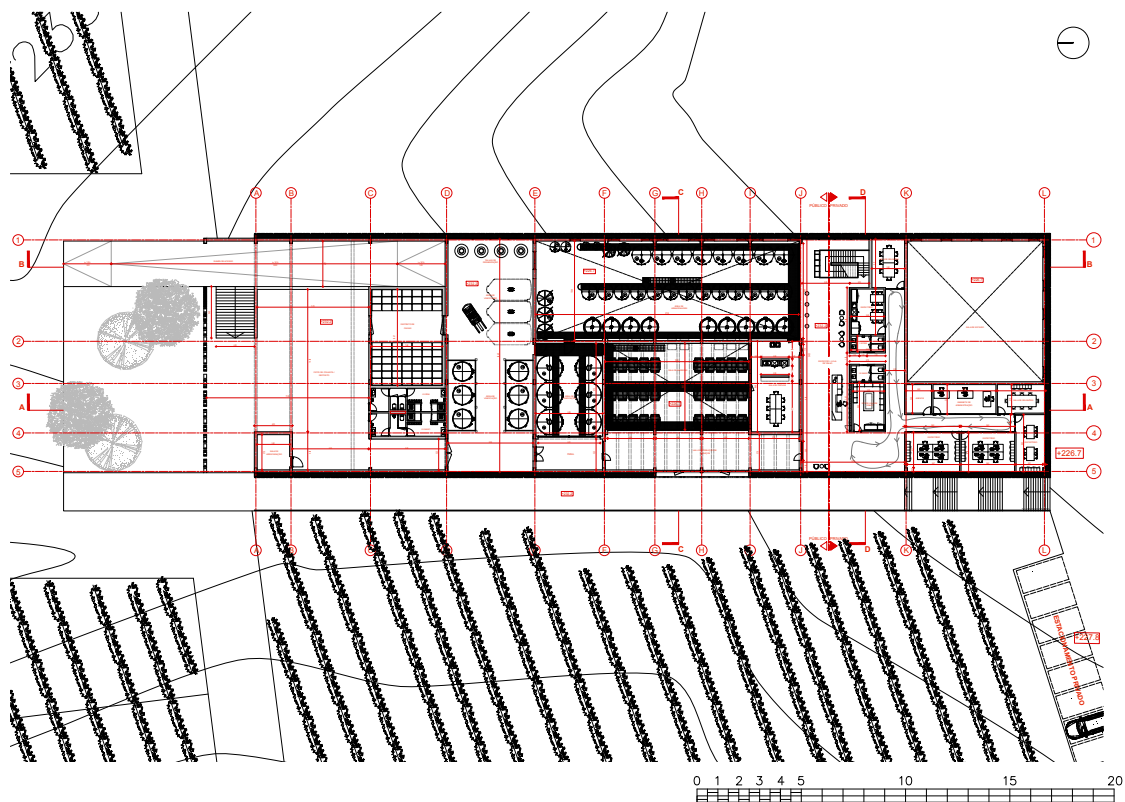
Planta do Piso Superior Proposta Esc. 1:200
